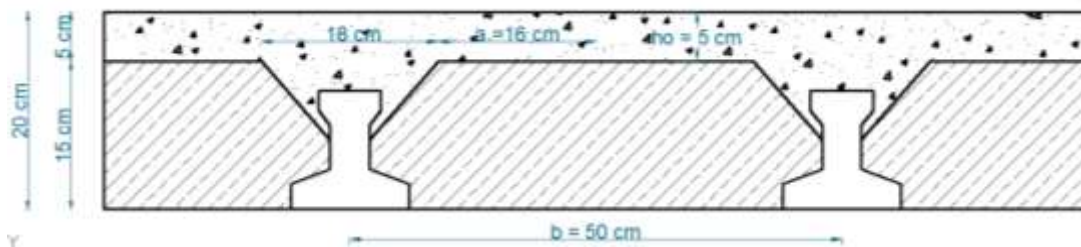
Espesor mínimo de la carpeta de hormigón y separación entre viguetas.
